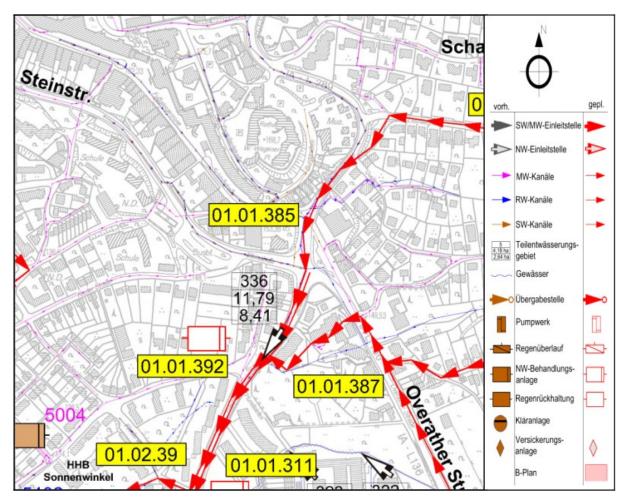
Auszug aus Lageplan (unmaßstäbliche Darstellung)
